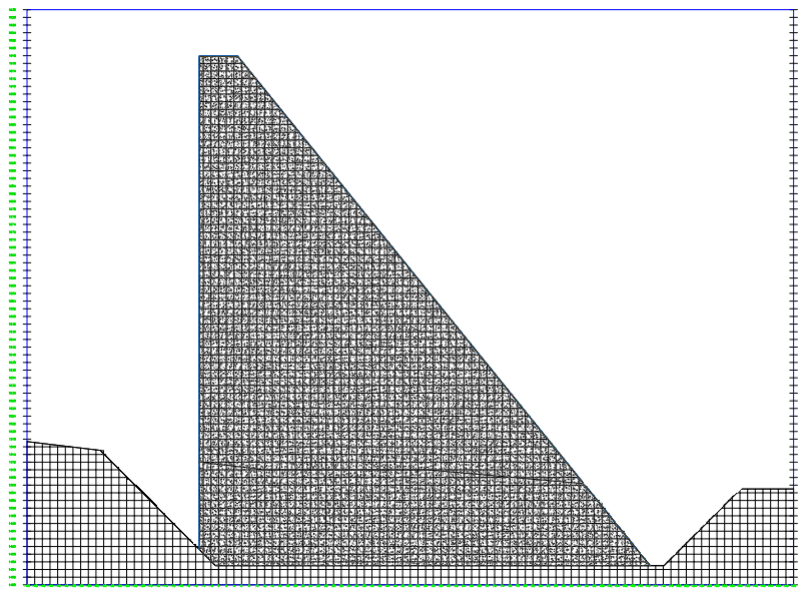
Sección Transversal Ejemplo Presa HCR Murallas Viejas, Civil 3D
